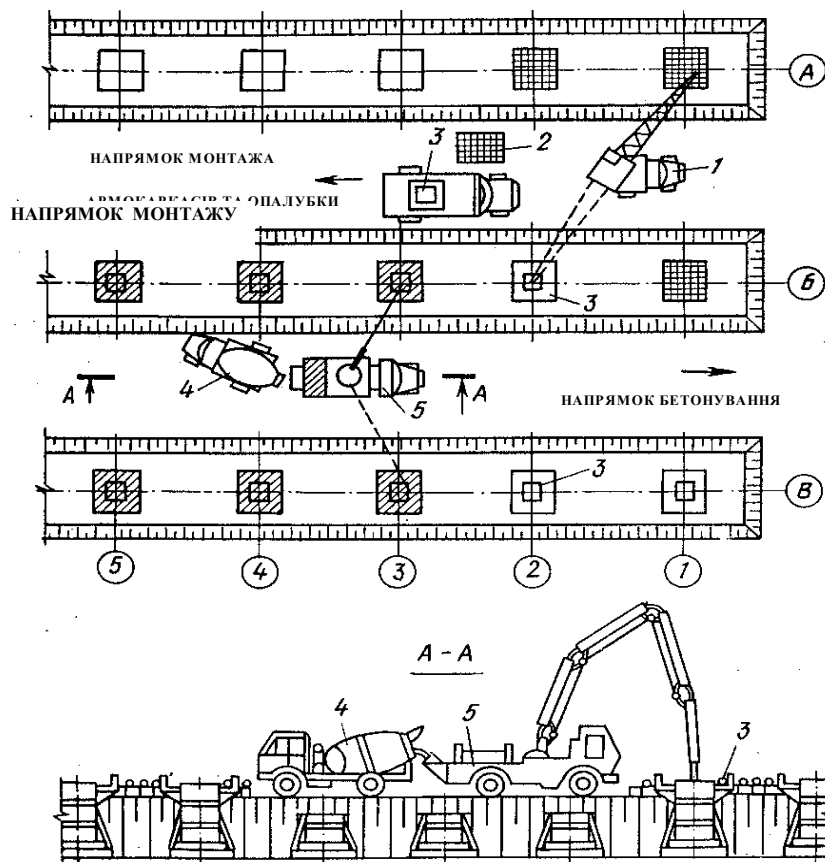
Схема поточкового проведення робіт при улаштуванні монолітних фундаментів:
